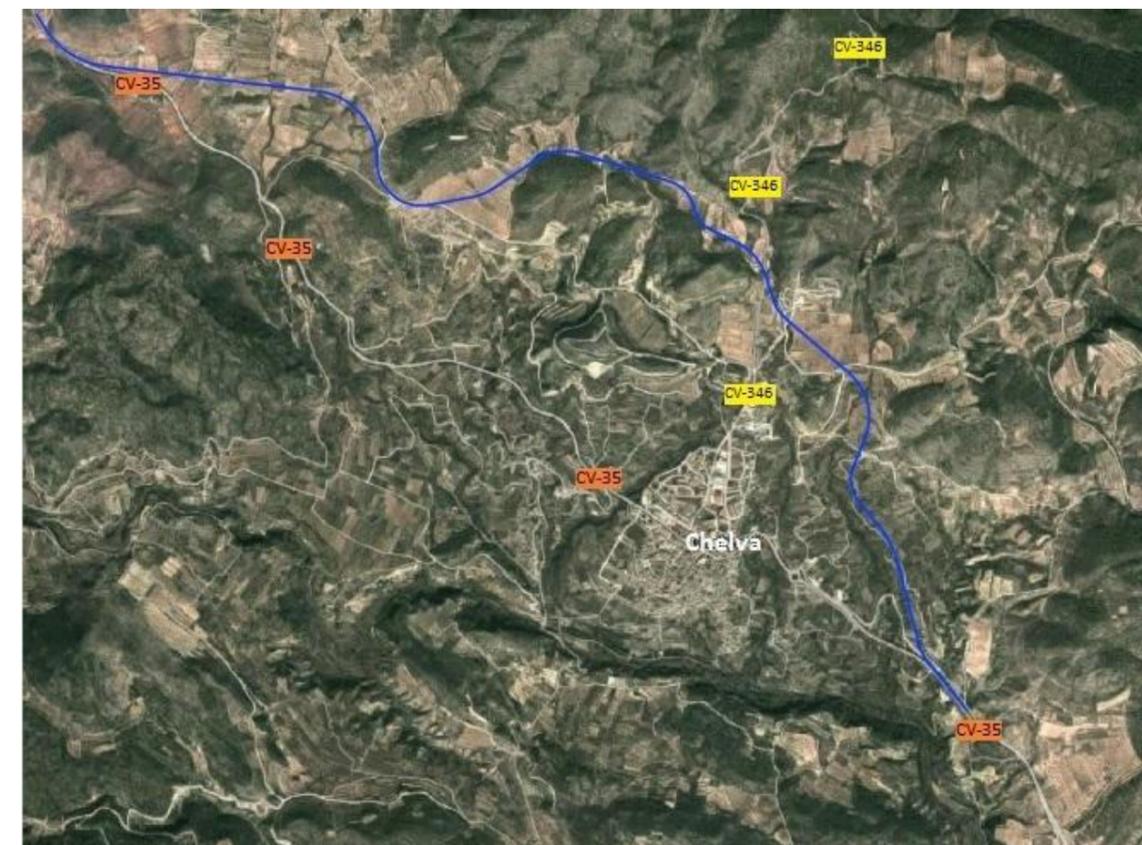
Trazado de Alternativa Norte. Fuente: Elaboración propia.
